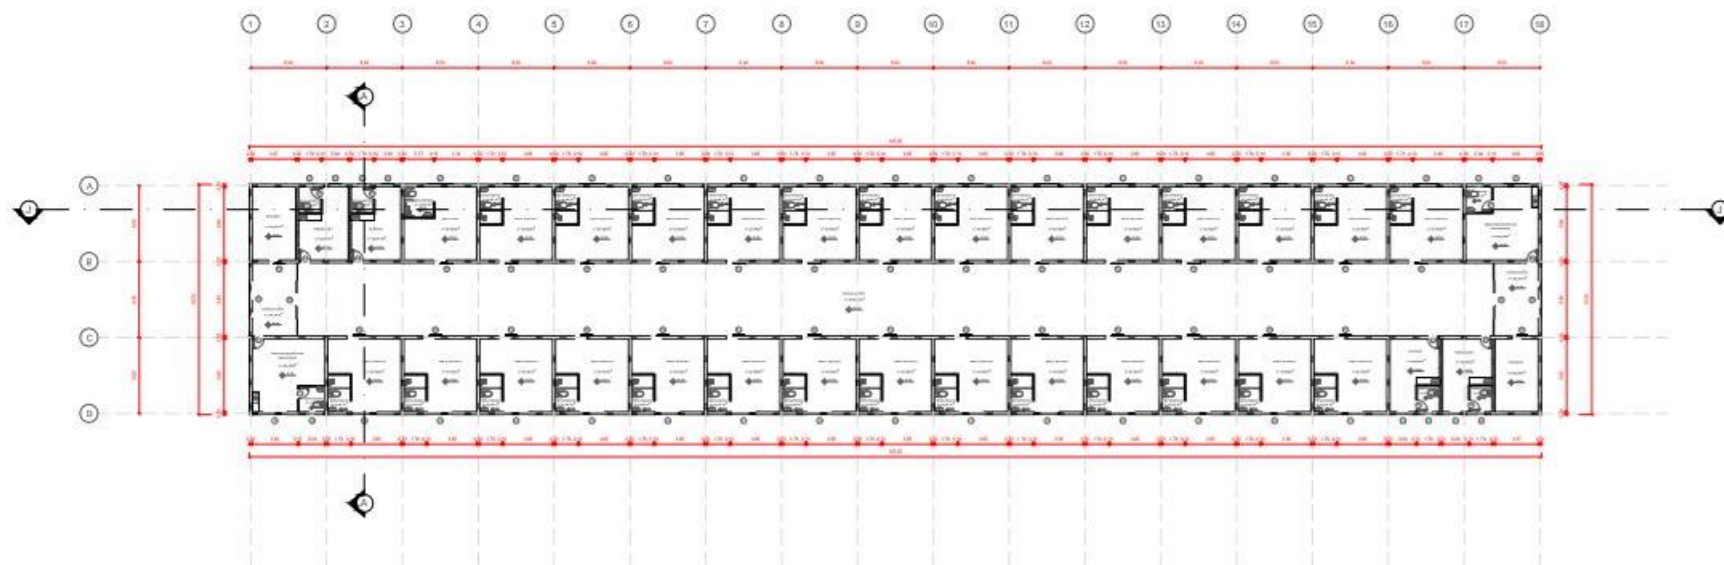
Planta Técnica – Fonte: Acervo Próprio
